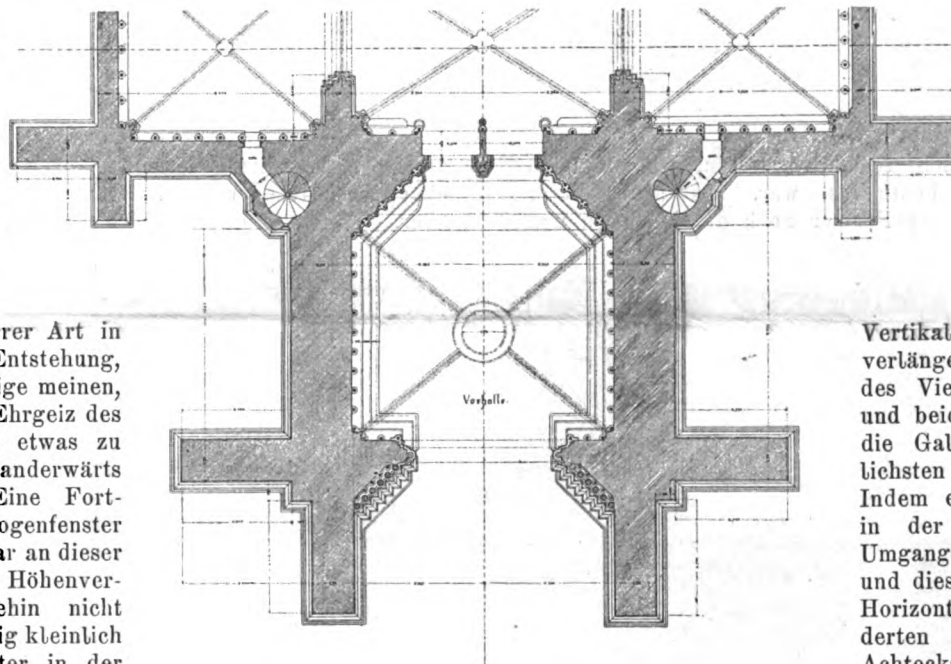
Thurmgrundriss im Erdgeschoss (Vorhalle).
